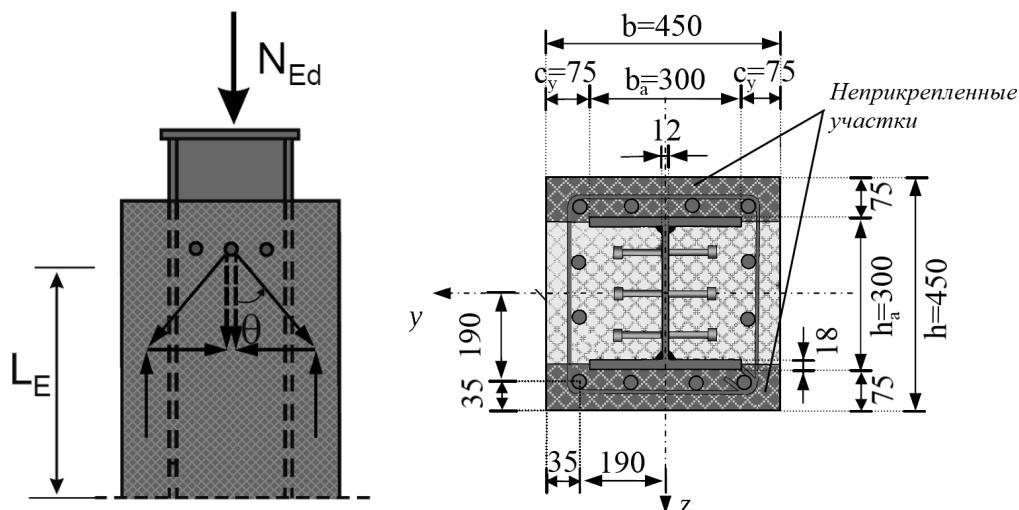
Пример расчета поперечного армирования из условия передачи усилий продольного сдвига в оголовке колонны
